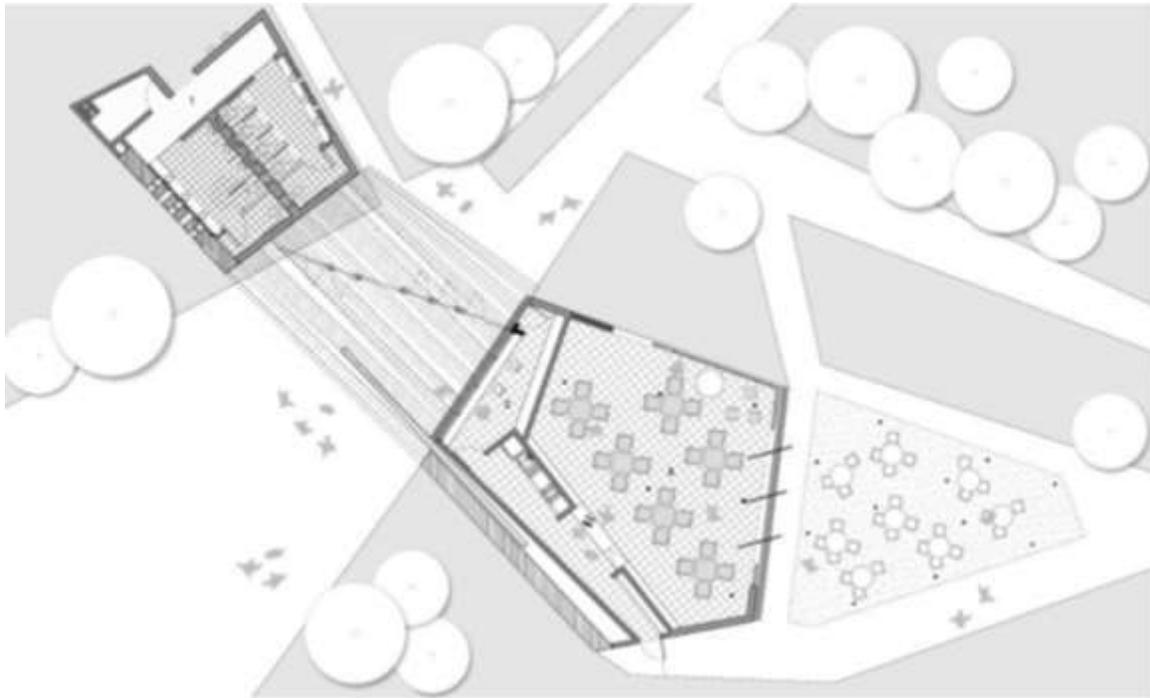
planta arquitectónica, tomada de [www.Archdaily.mx](http://www.Archdaily.mx), el 23/10/17, edición propia
